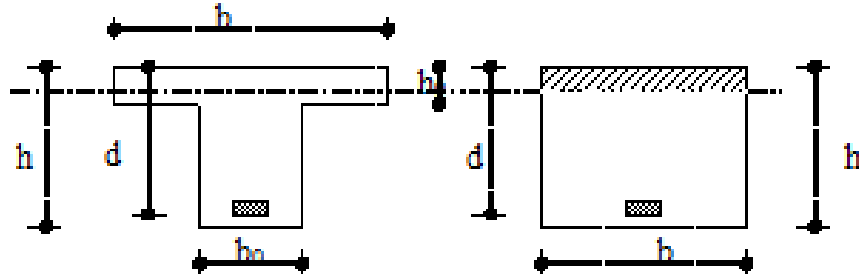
Coupe de Section Rectangulaire et Section en T
